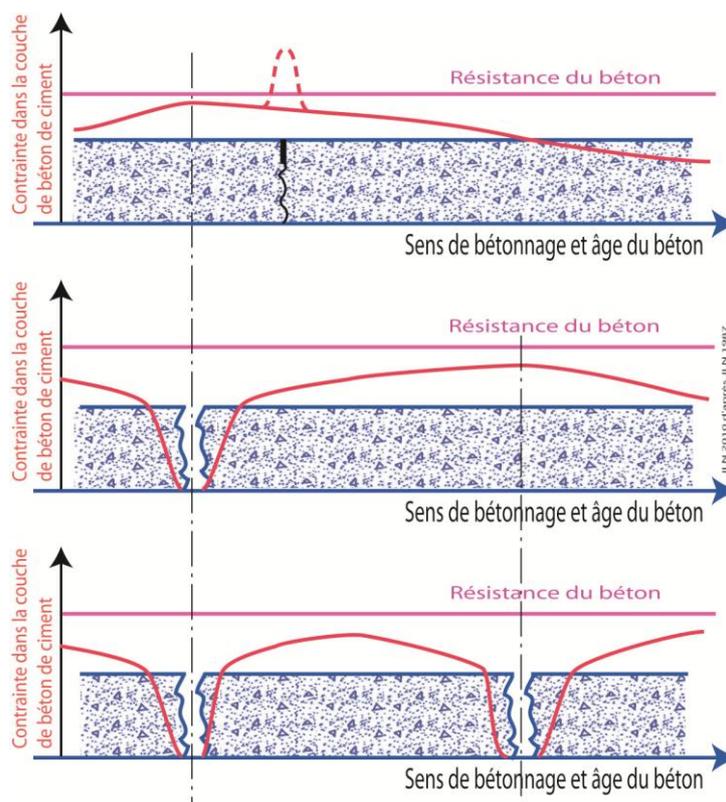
Fissuration d'un revêtement en béton non armé
